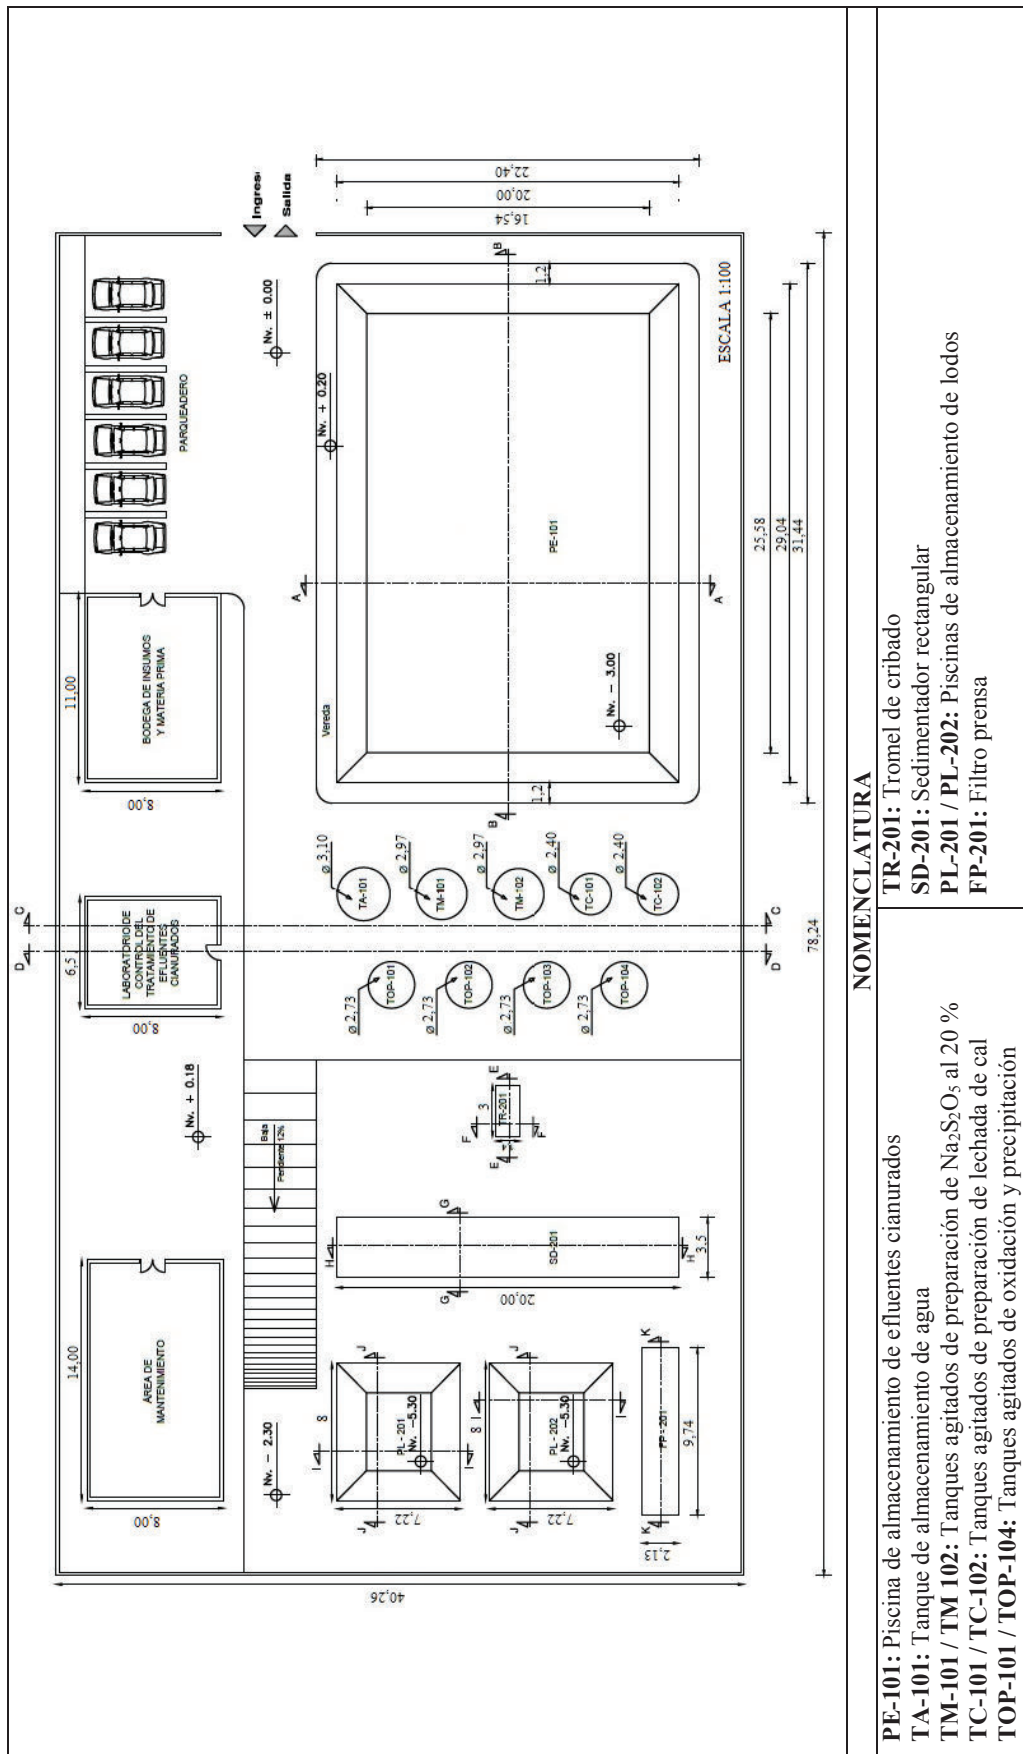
Distribución en planta (lay out) de la planta de tratamiento efluentes cianurados
